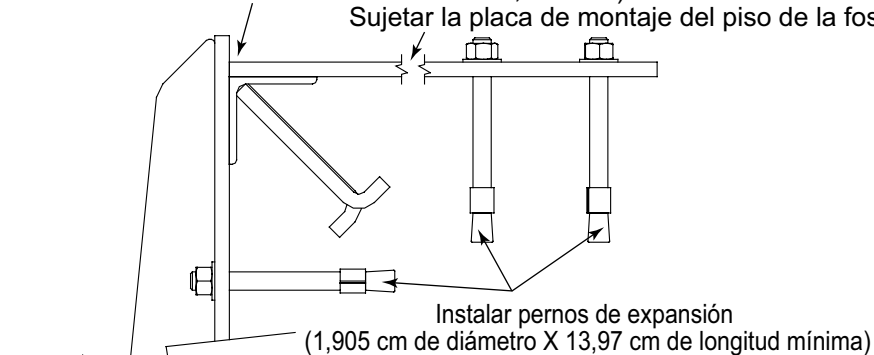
(Soldar la placa de montaje del piso de la fosa a la placa posterior de la unidad de cierre con una soldadura con filete continuo de 0,635 cm.)
